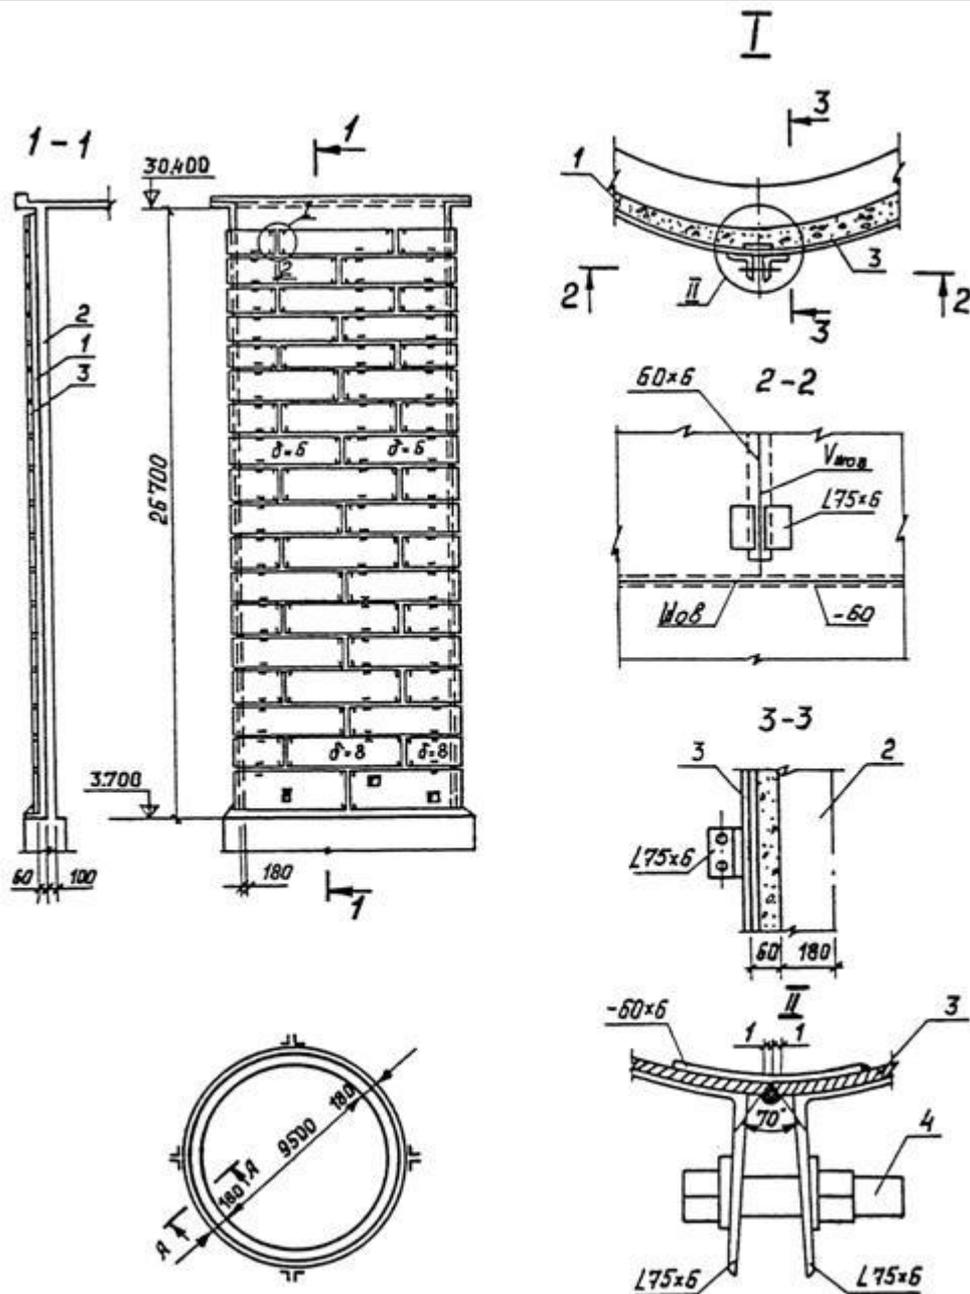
Усиление железобетонного силоса стальной обечайкой
